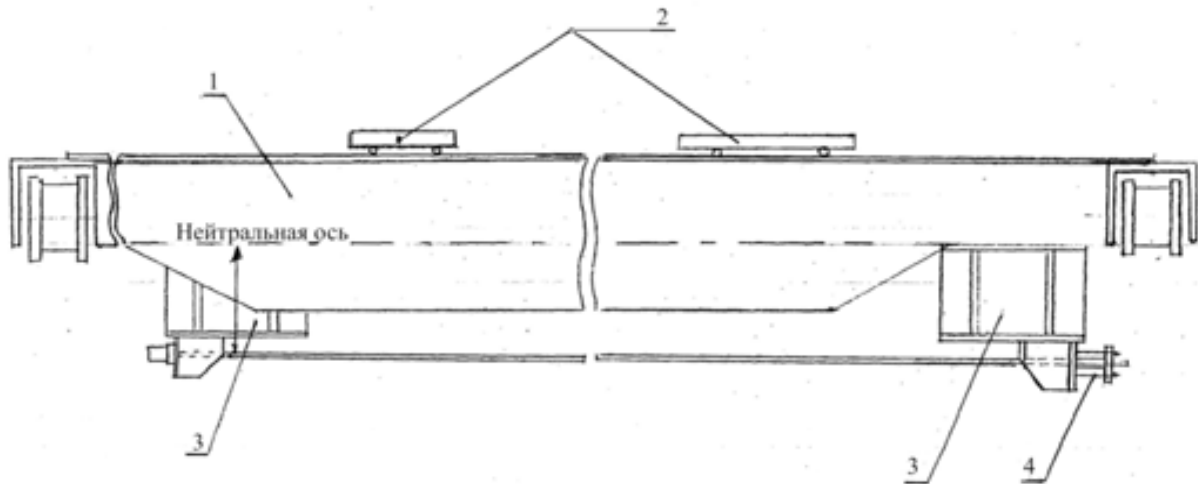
Пристрій для створення попереднього напруження головної балки (встановлений на крані без його демонтажу): 1 – головна балка; 2 – візки крана; 3 – опори; 4 – натягач (домкрат)
